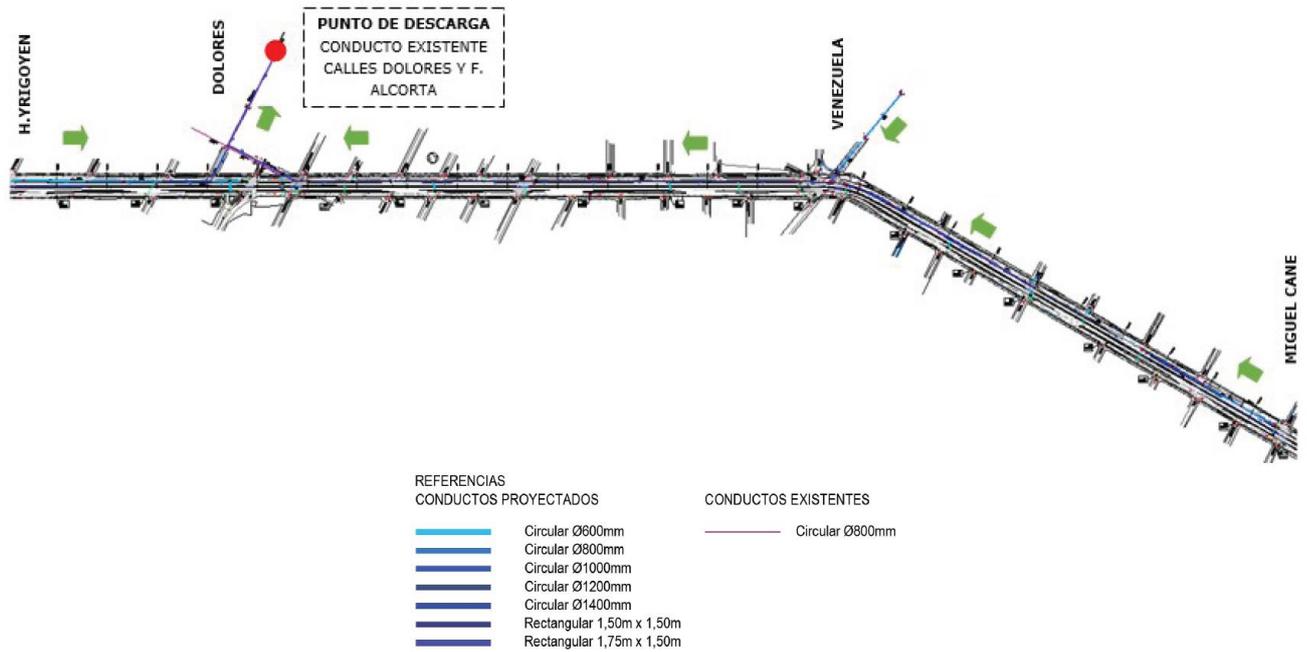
Planta subsistema descarga en conducto existente de calles Dolores y F. Alcorta
